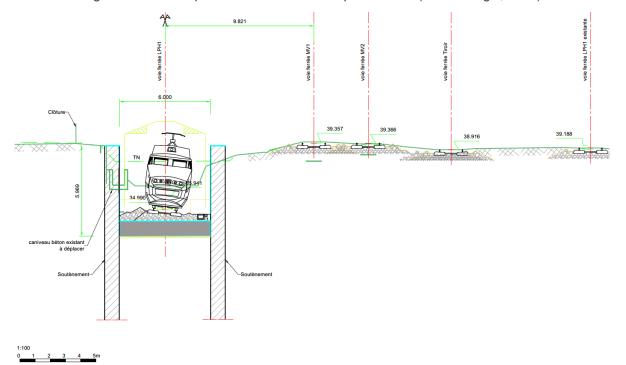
Coupe 1 - vue en coupe de la rampe d'accès ouest du terrier (source : Egis, 2021)
